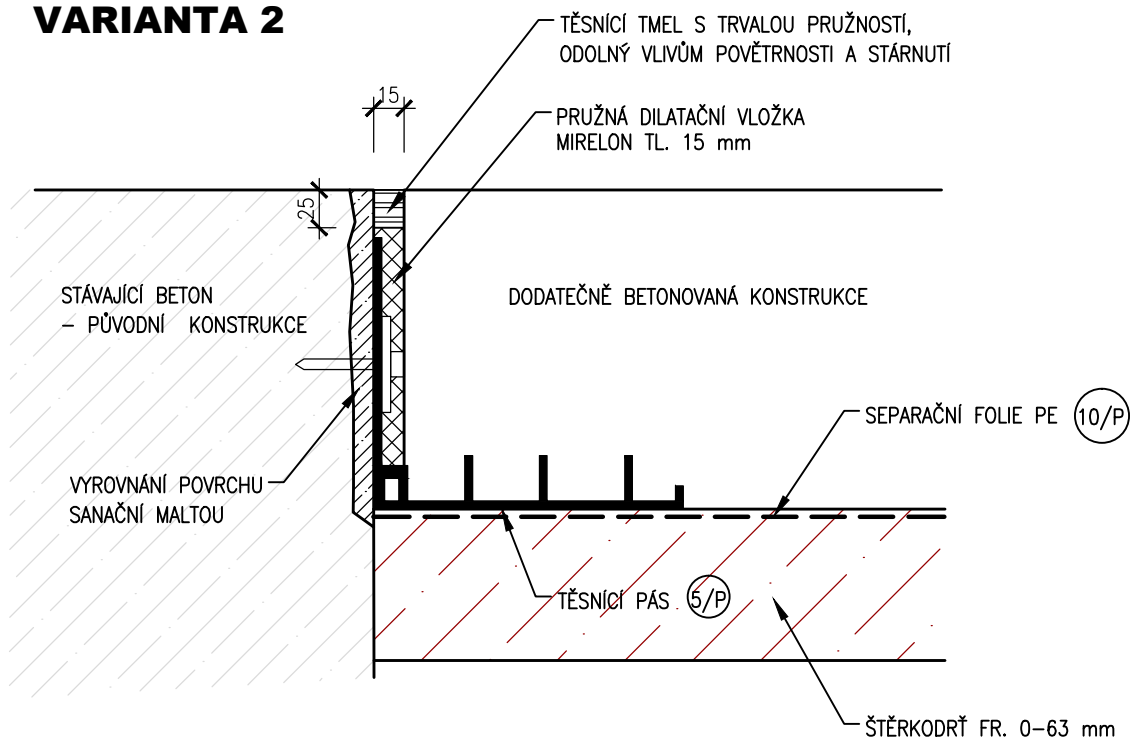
DETAIL - TĚSNĚNÍ PROFILEM 5/P
